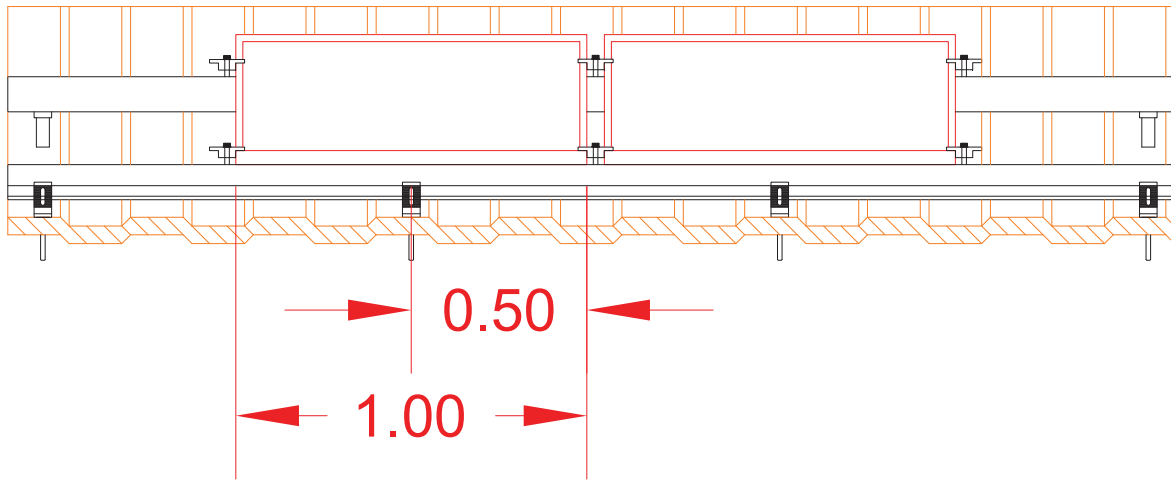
Vista Lateral de estructuras para techos horizontales.
